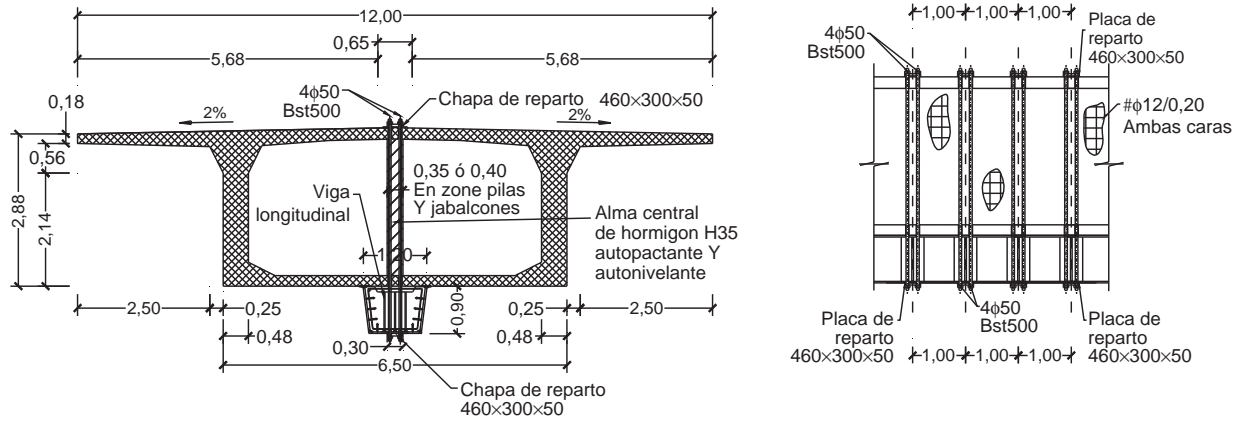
Alzado y sección transversal del alma central y el cajón metálico longitudinal.
